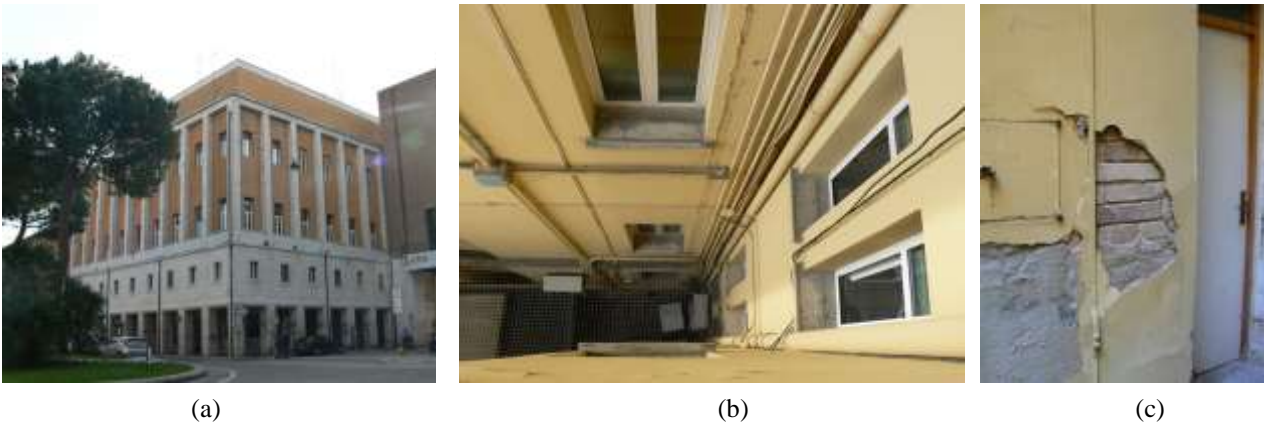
(a) Vista dei prospetti (a) esterni e (b) interni del fabbricato; (c) porzione di intonaco danneggiato nel cortile interno, con tessitura muraria a vista.
